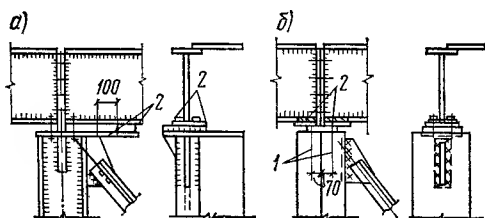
Опираие подкрановых балок на колонны связевых панелей
